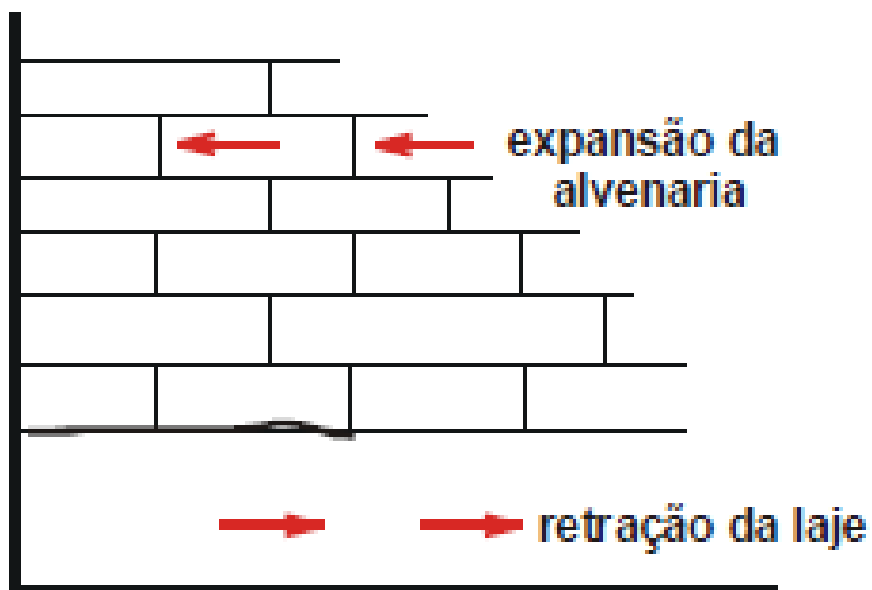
Trincas e fissuras verticais na parede de alvenaria por retração da laje.
